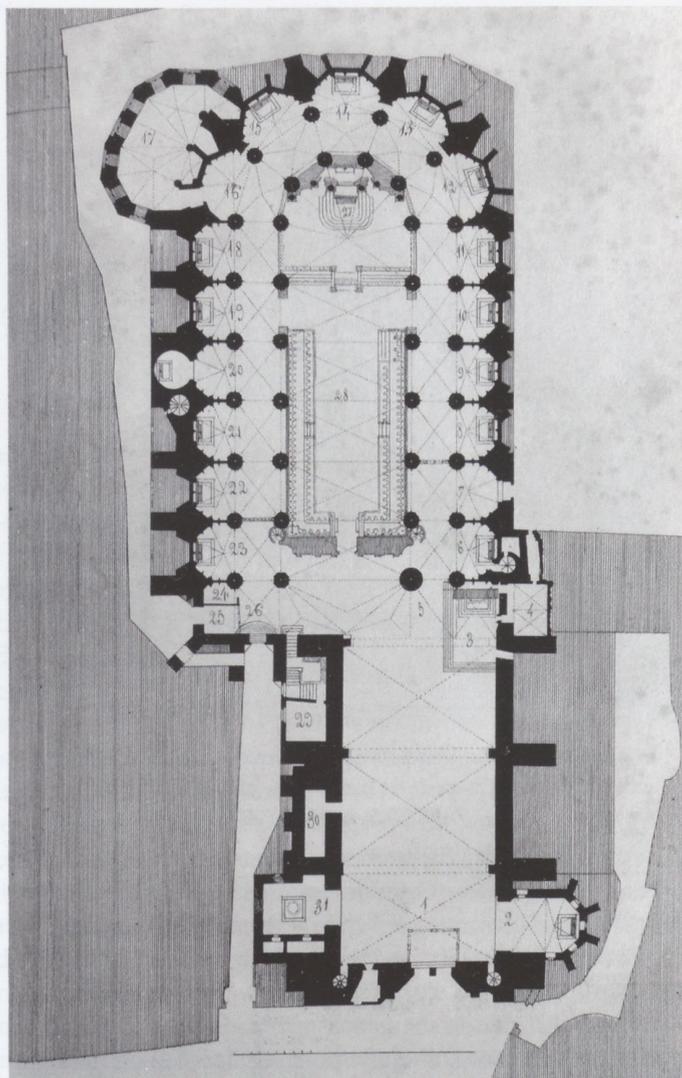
Toulouse, plan de la cathédrale vers 1800, plan Laffont, début du XIX^e siècle d'après Aldéguer 1832-1833
